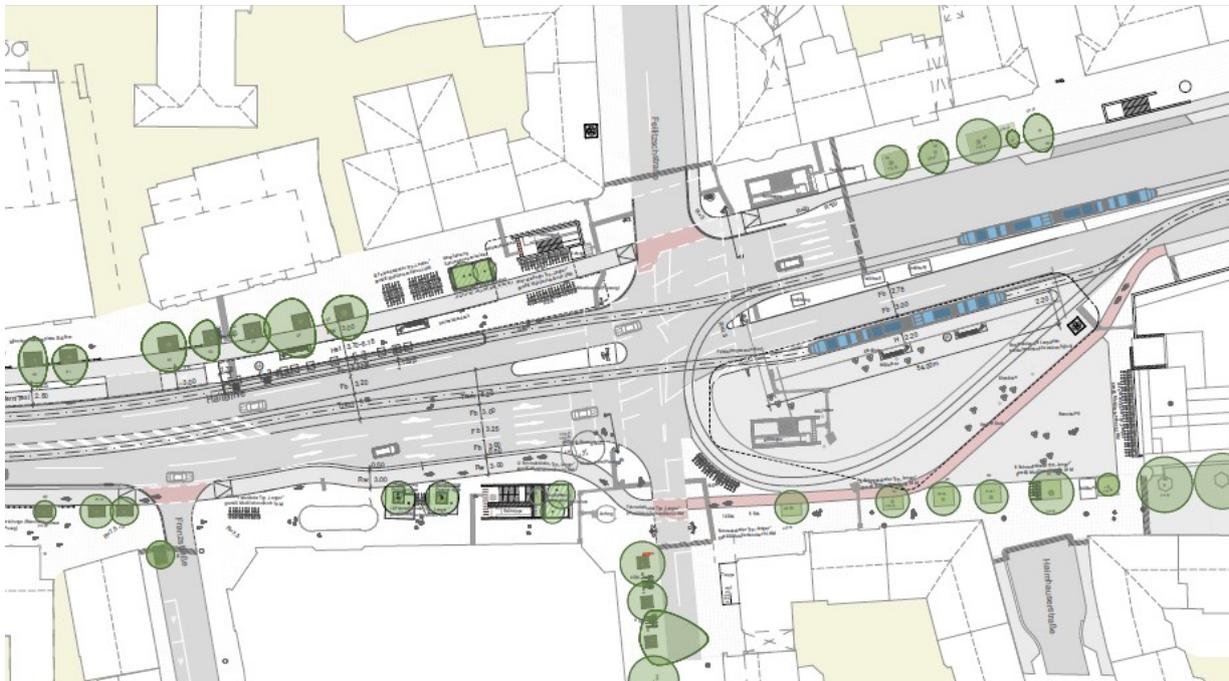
Lageplan V2 (Quelle: SWM/MVG, mgk Landschaftsarchitekten)
